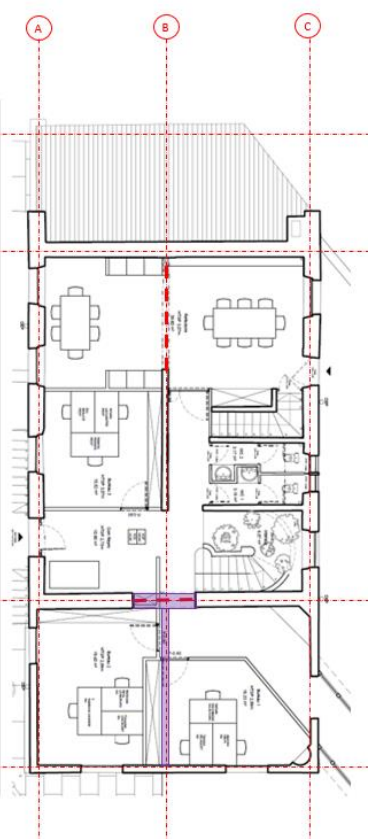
Plan architecte RDC, états existants & projeté, juin 2022
